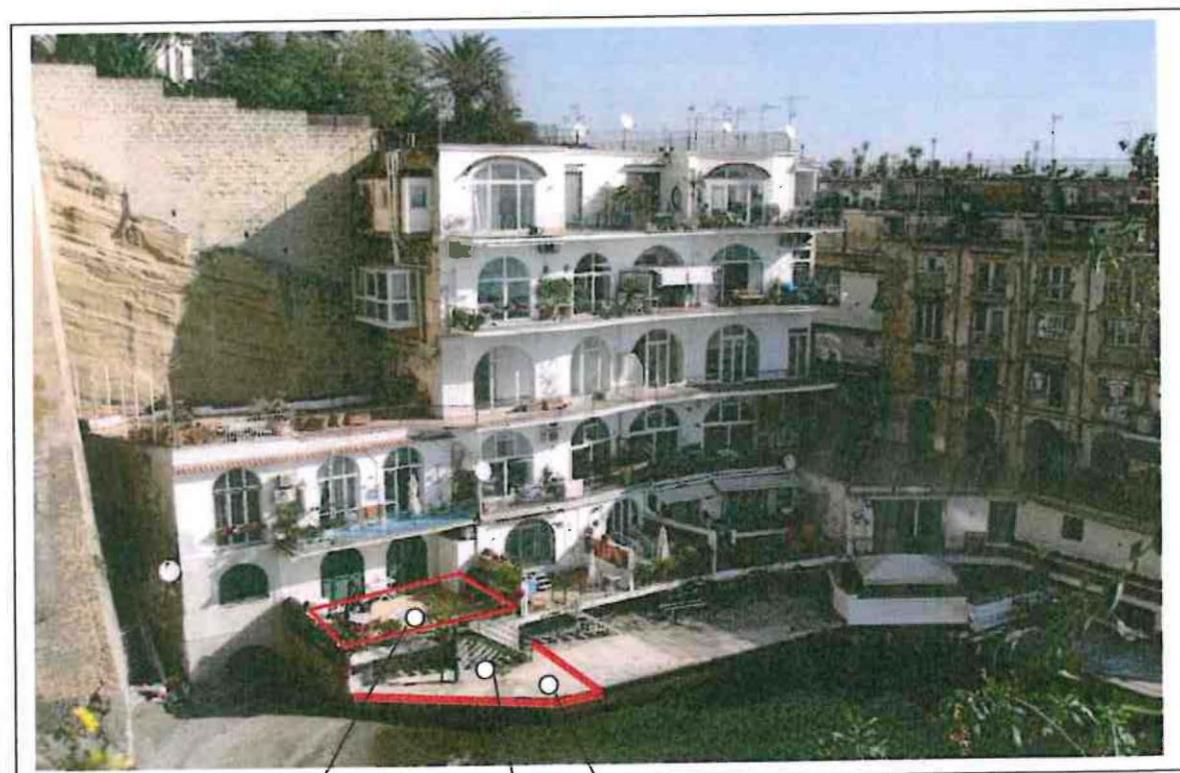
Vista aerea delle zone oggetto della richiesta di concessione
